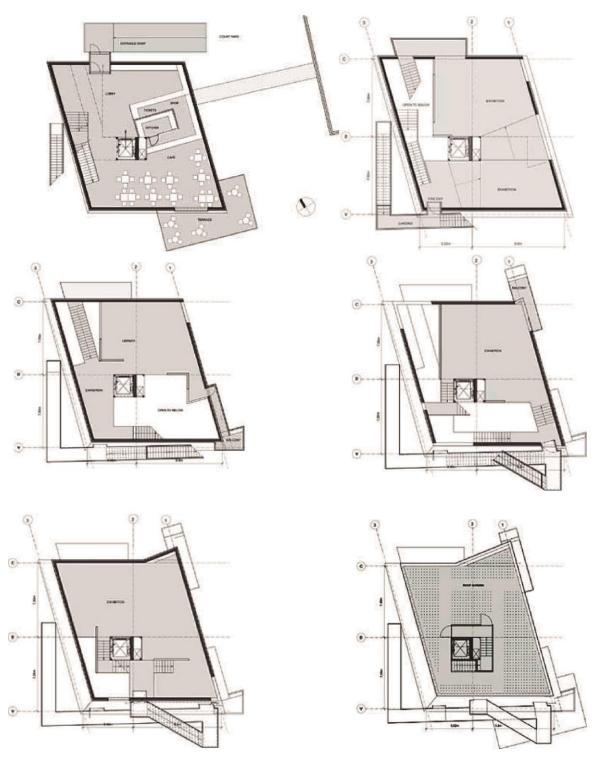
Planos del Proyecto del Museo Knut Hamsun. Plantas.
